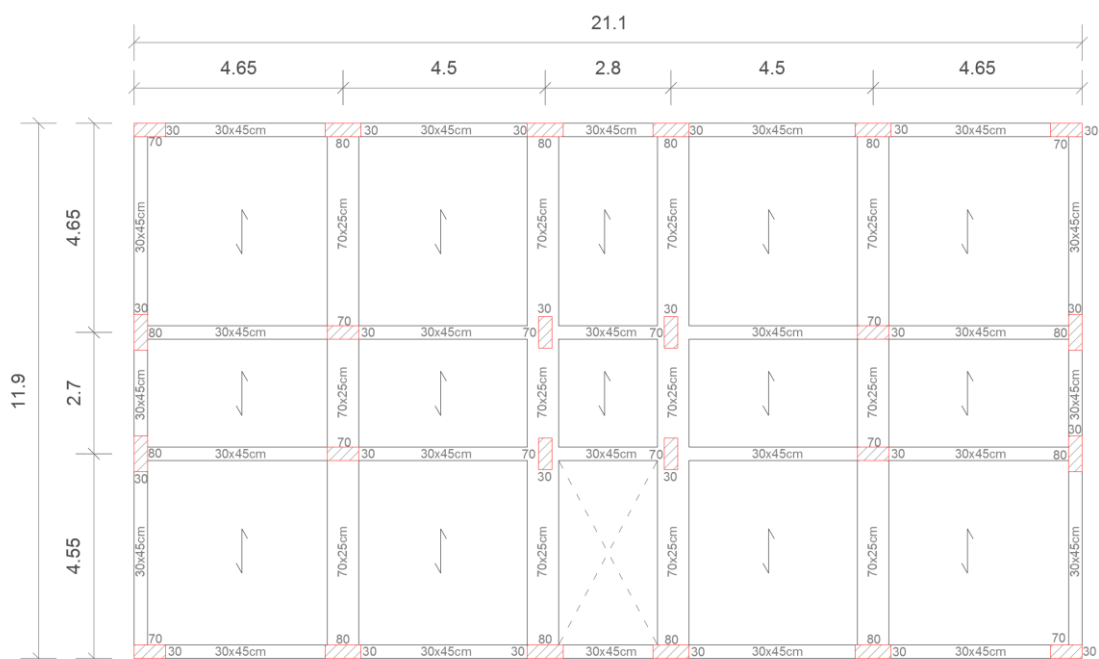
Carpenteria secondo solaio struttura in c.a. a tre piani.
